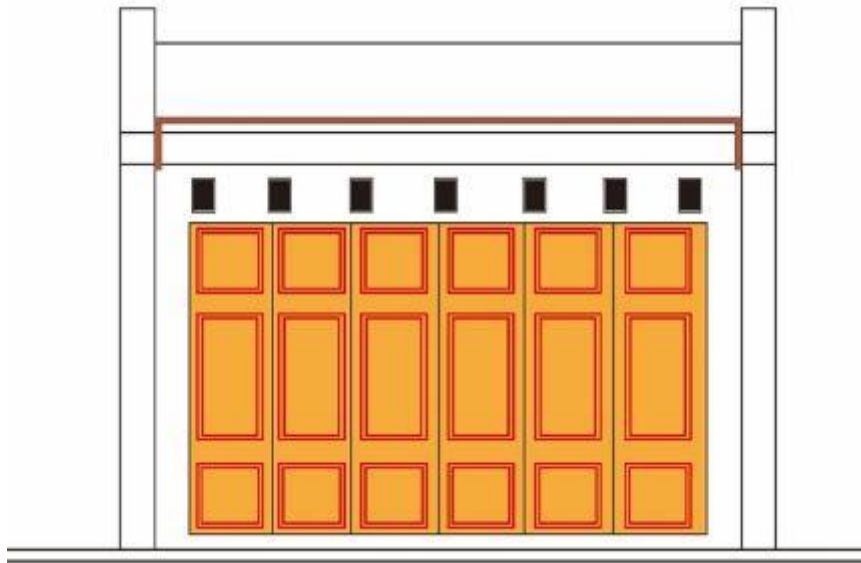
Tampak Timur ( sisi samping) Bangunan.
